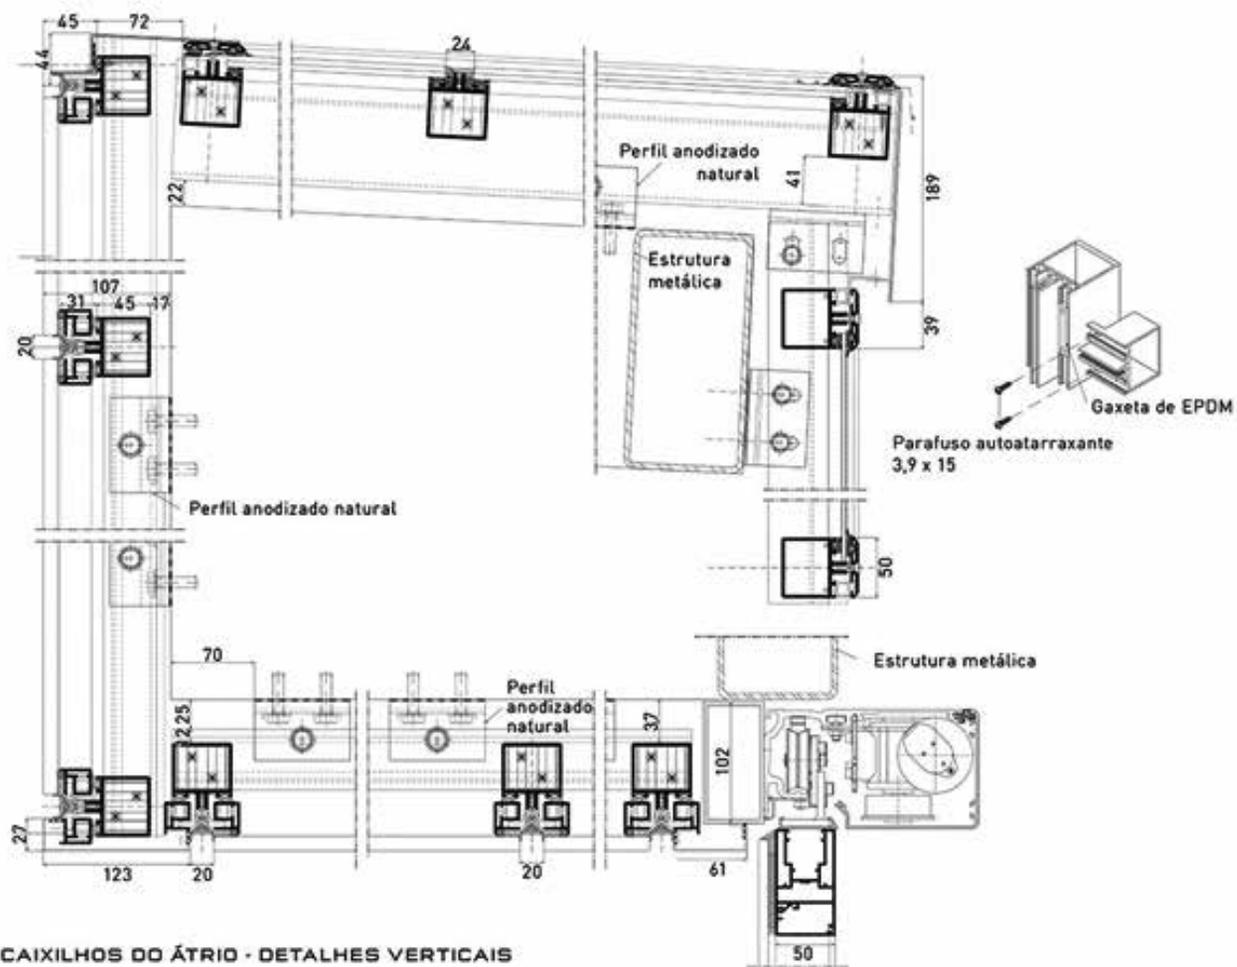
Detalhes do sistema Structural Glazing e suas fixações. (GELINSKI, 2013a)
